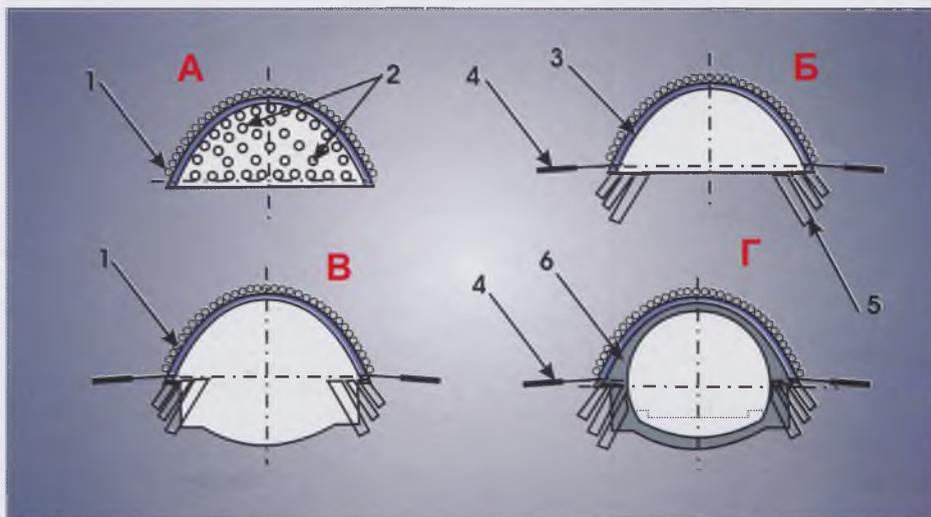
Этапы проходки (А-Г) тоннеля Прапоптин: 1- экран из грунтоцементных столбов; 2 - фибергласовые нагели; 3 - арочная крепь; 4 - анкеры; 5 - наклонные микросваи; 6 - обделка тоннеля
